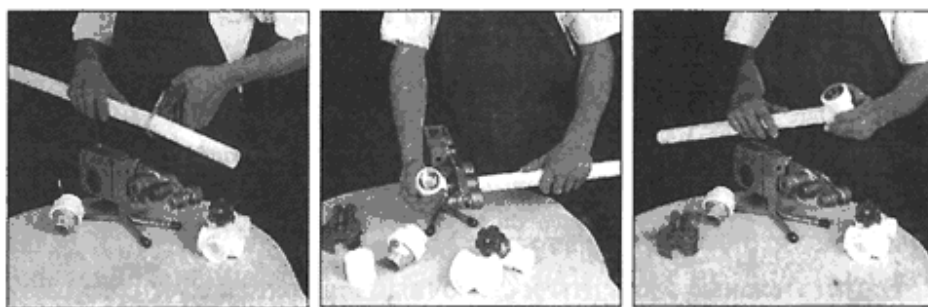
Основные операции раструбной сварки: резка, нагрев, соединение
